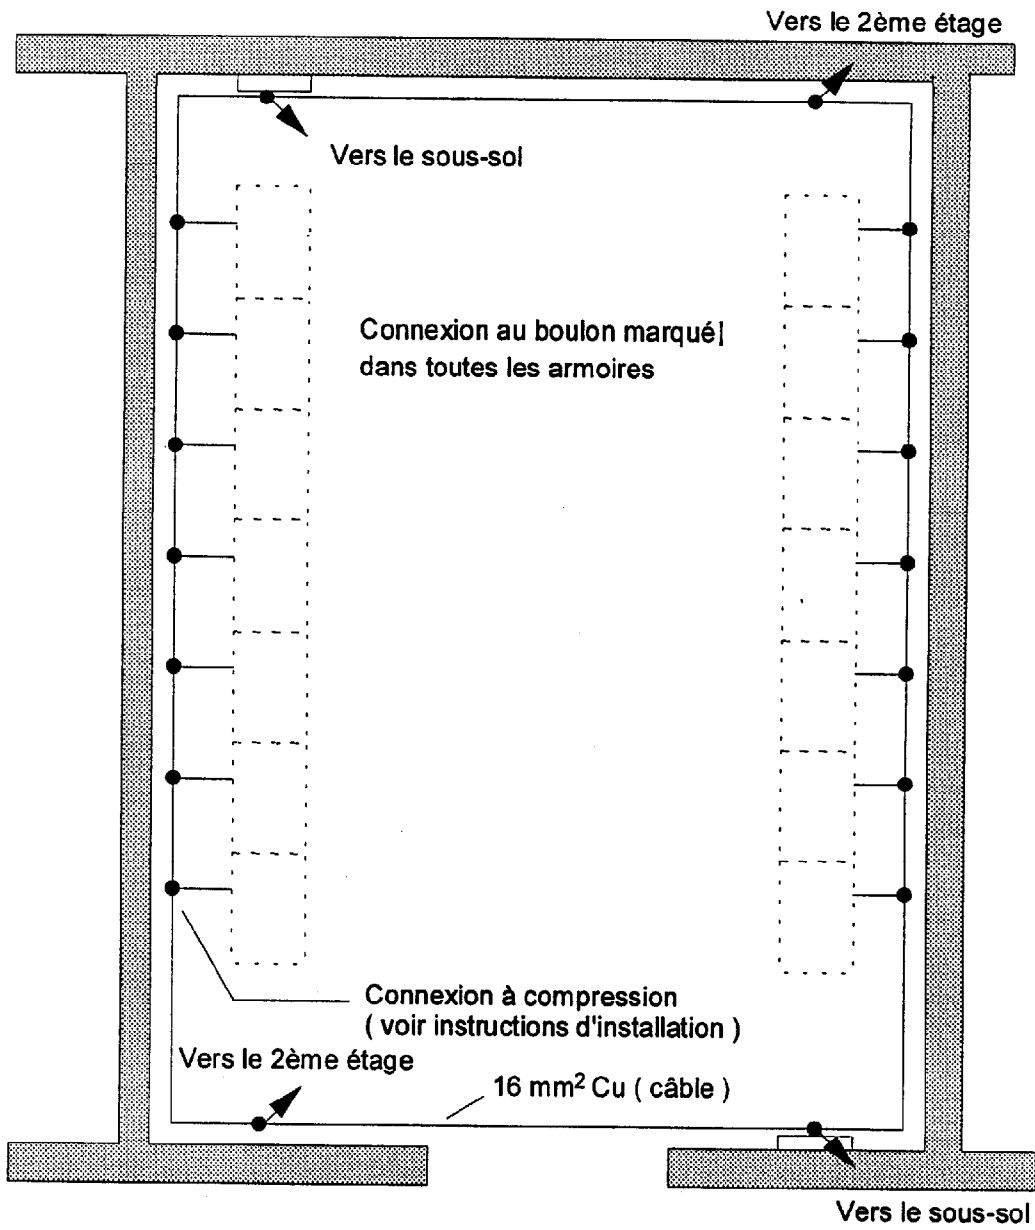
Exemple de schéma de mise à la terre d'un bâtiment: salle de commande (voir 5.3.4)
